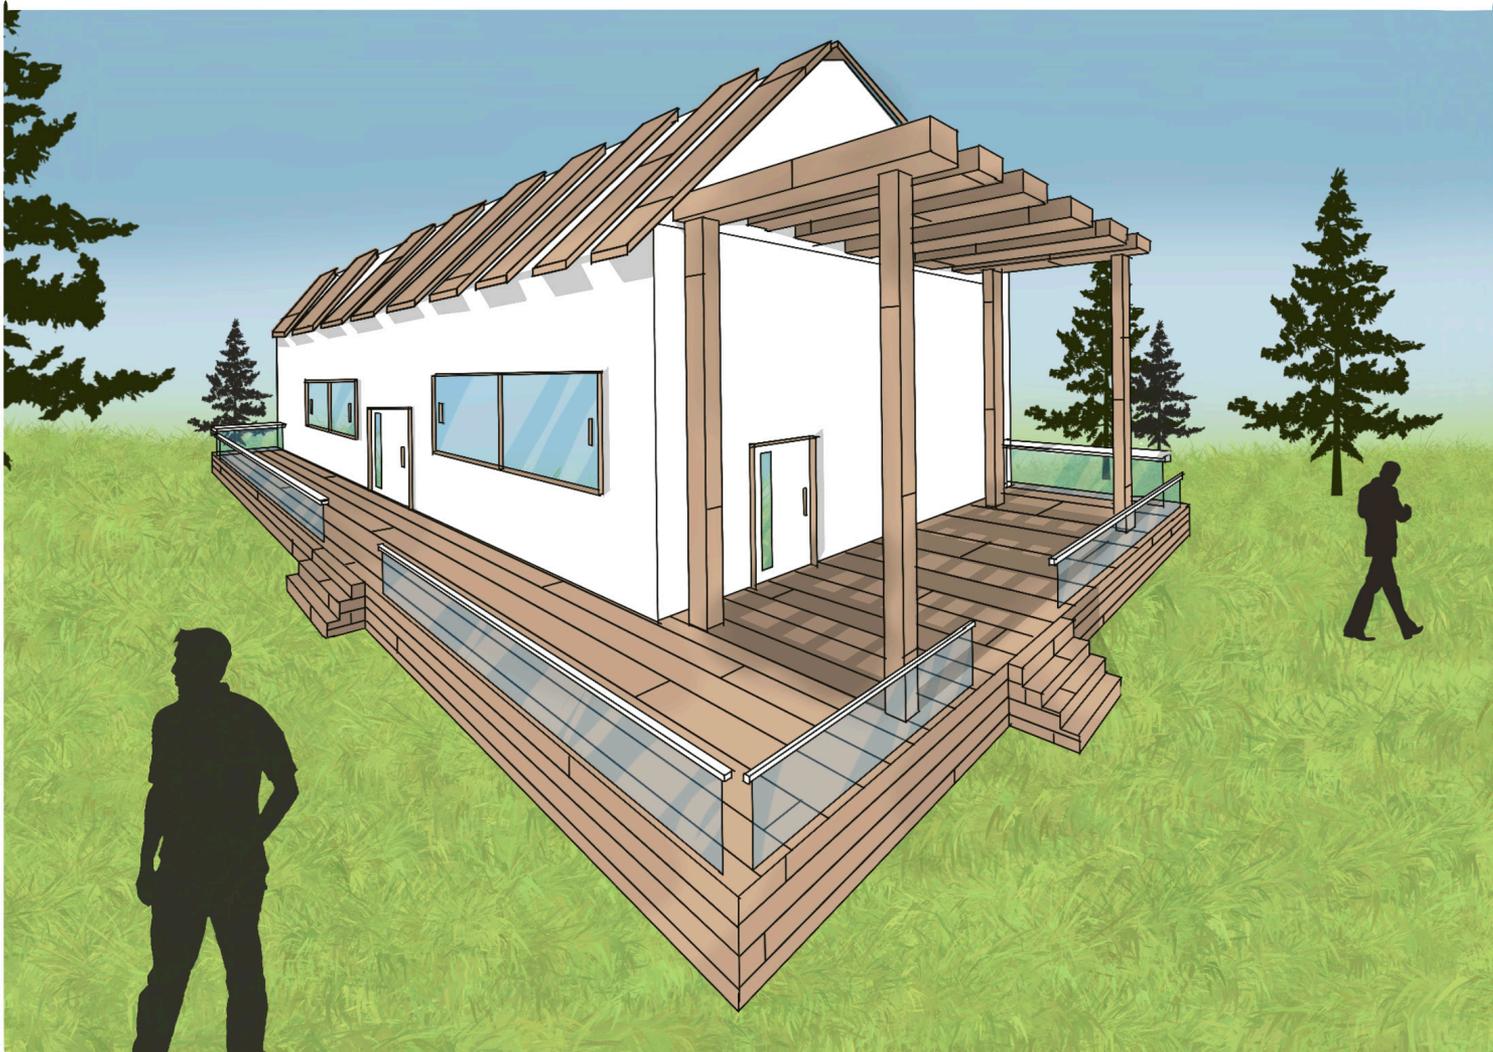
Vista en perspectiva de la vivienda de doble ancho. Fuente: autoría propia.
